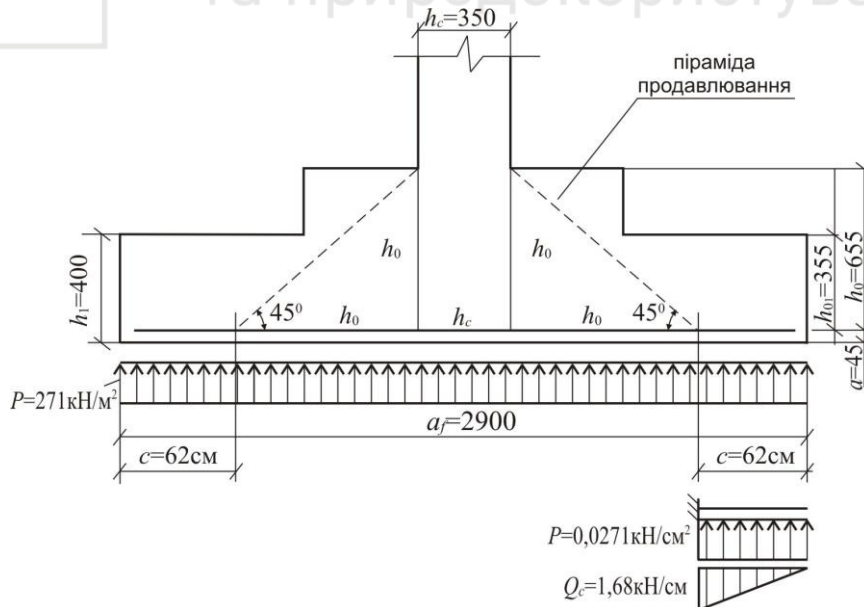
До розрахунку фундаменту на продавлювання.
